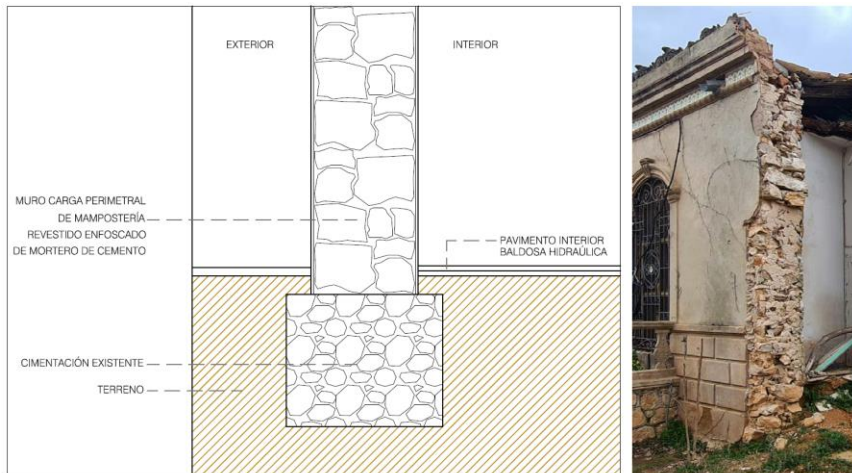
Esquema de la cimentación y muro perimetral. 2023. Fuente: propia.
